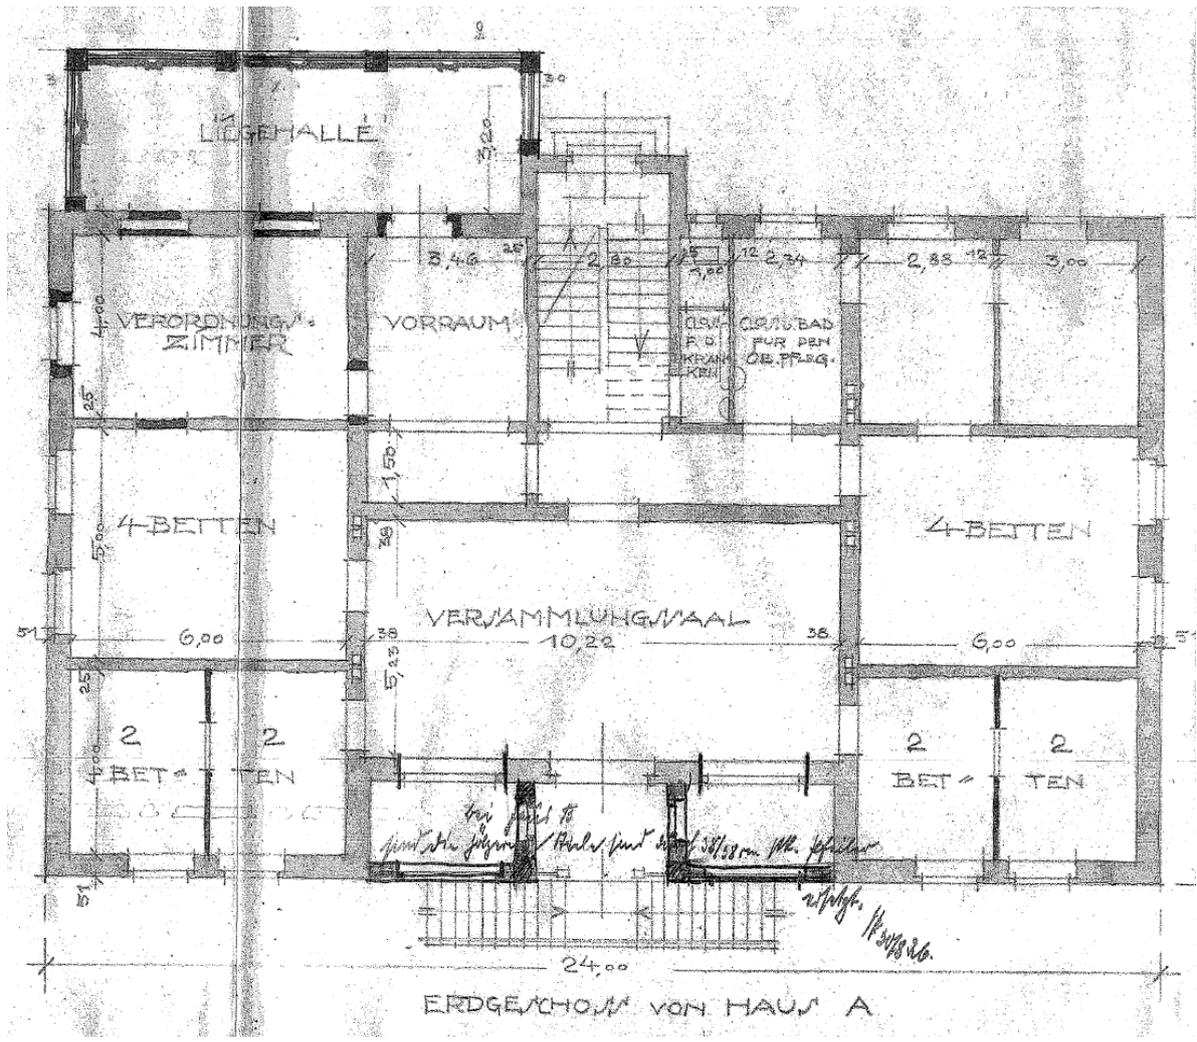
Grundriss Erdgeschoss Haus A<sup>68</sup>
